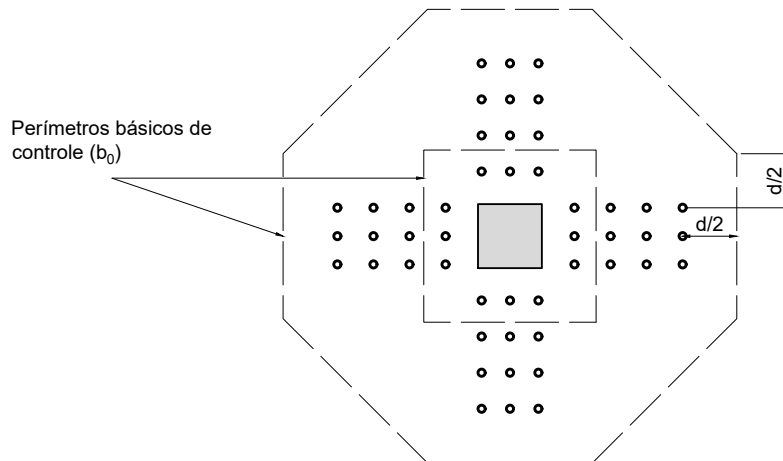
Perímetro básico na presença de armadura transversal (ACI 318)
